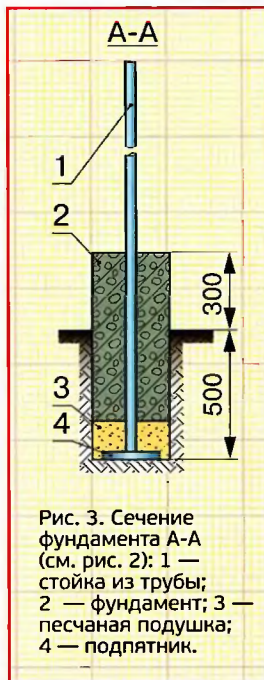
Сечение фундамента А-А (см. рис. 2): 1 — стойка из трубы; 2 — фундамент; 3 — песчаная подушка; 4 — подпятник.
